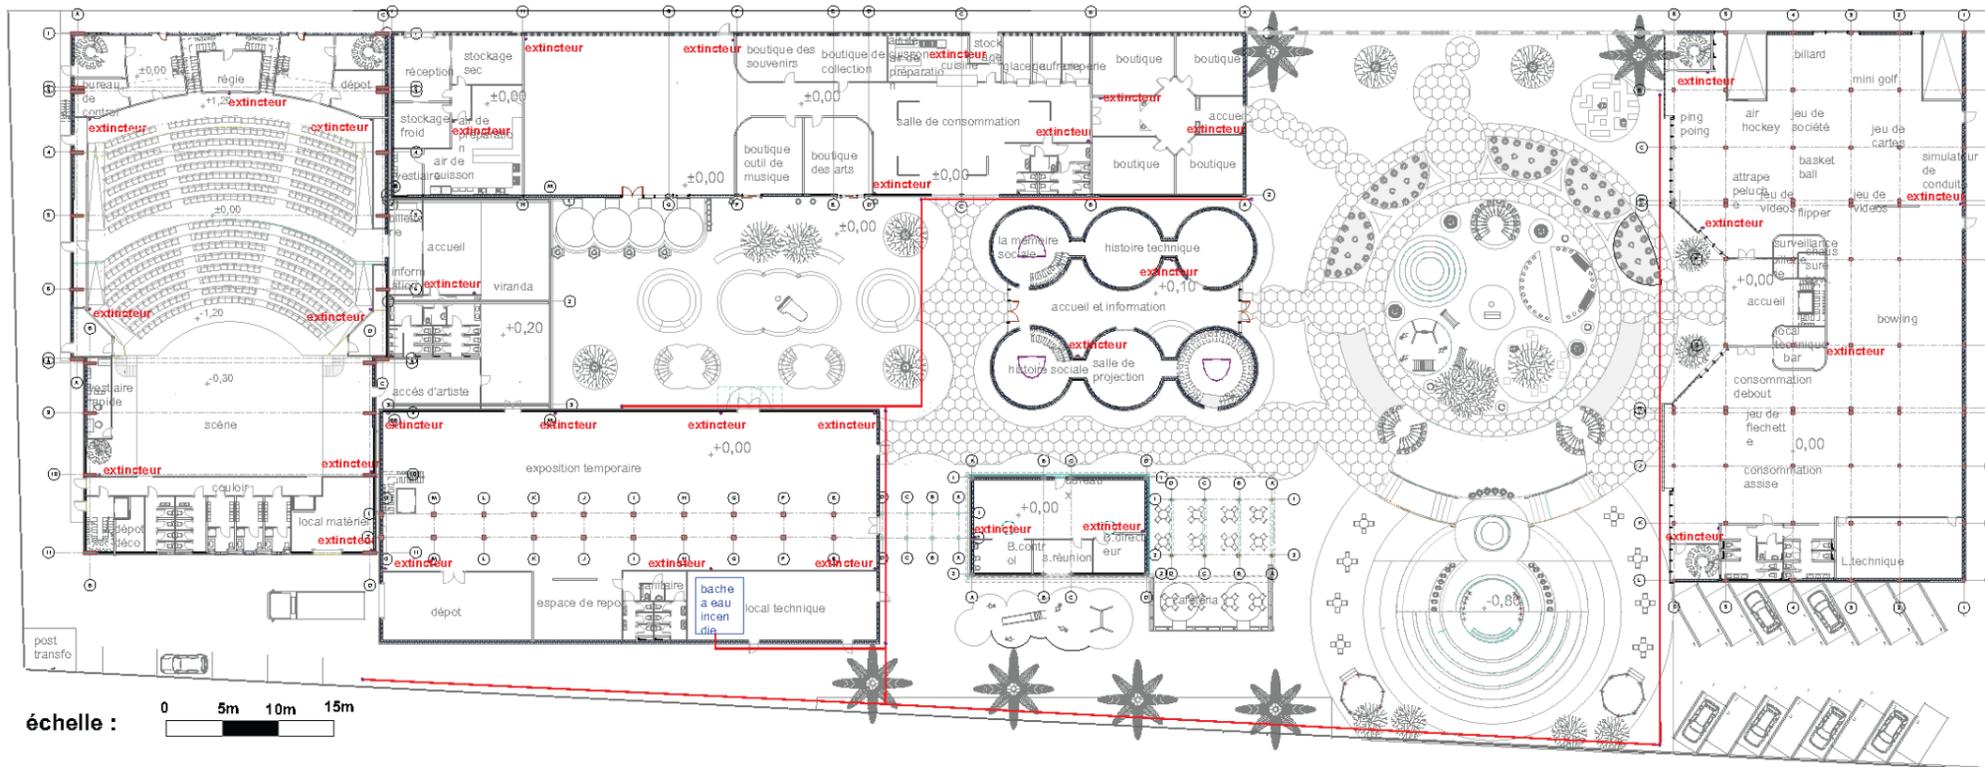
plan de protection incendie rez-de-chaussée. 1/600.
